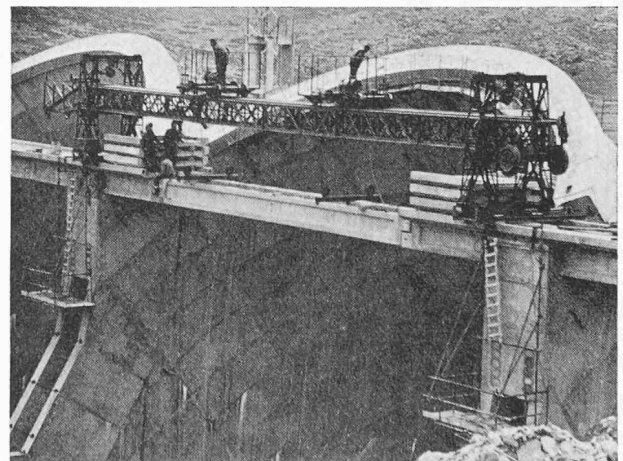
Mise en place d'une travée intermédiaire de la passerelle. On distingue, en attente, les éléments de dalles préfabriquées.
